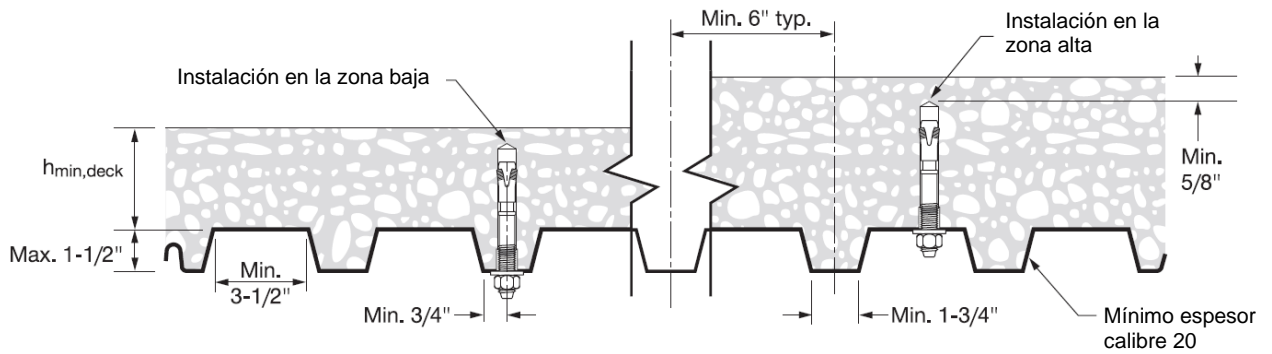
Instalación sobrecabeza en concreto sobre cubierta metálica - plataforma tipo B
